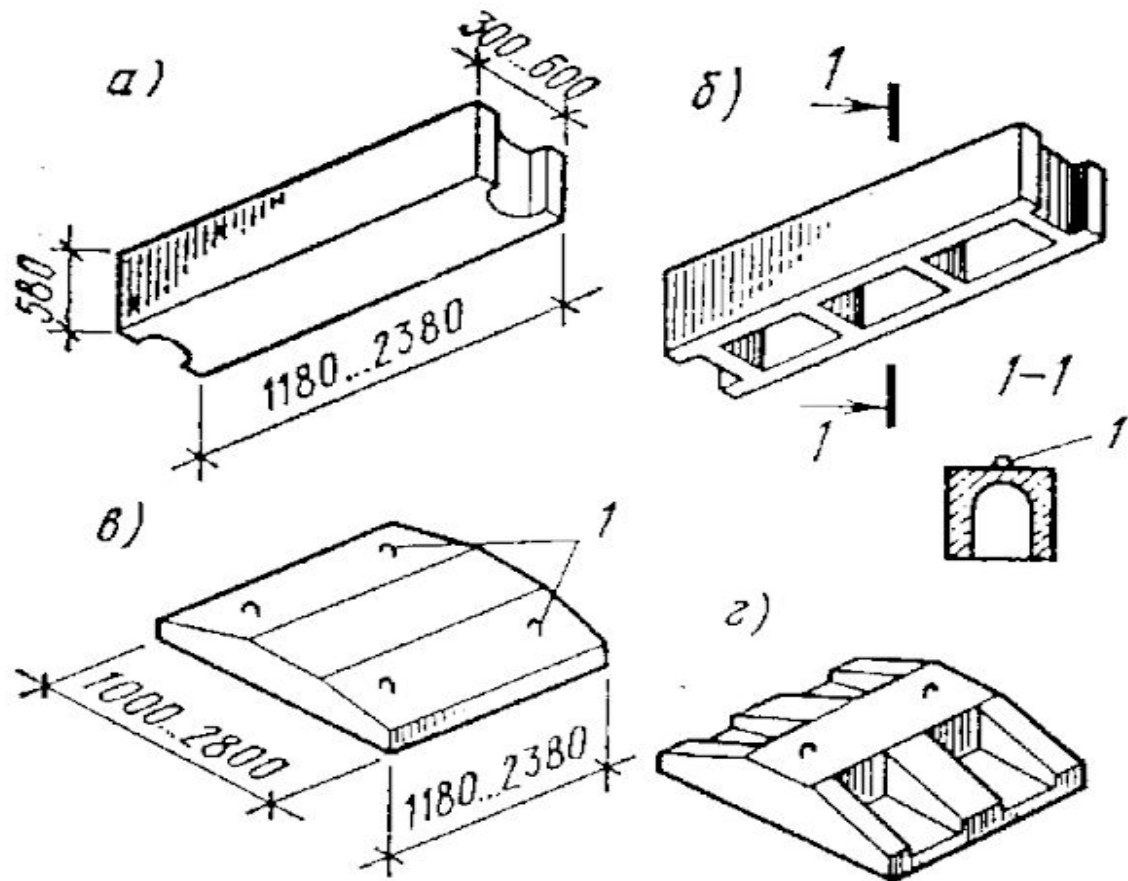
Элементы сборных бетонных и железобетонных фундаментов:
